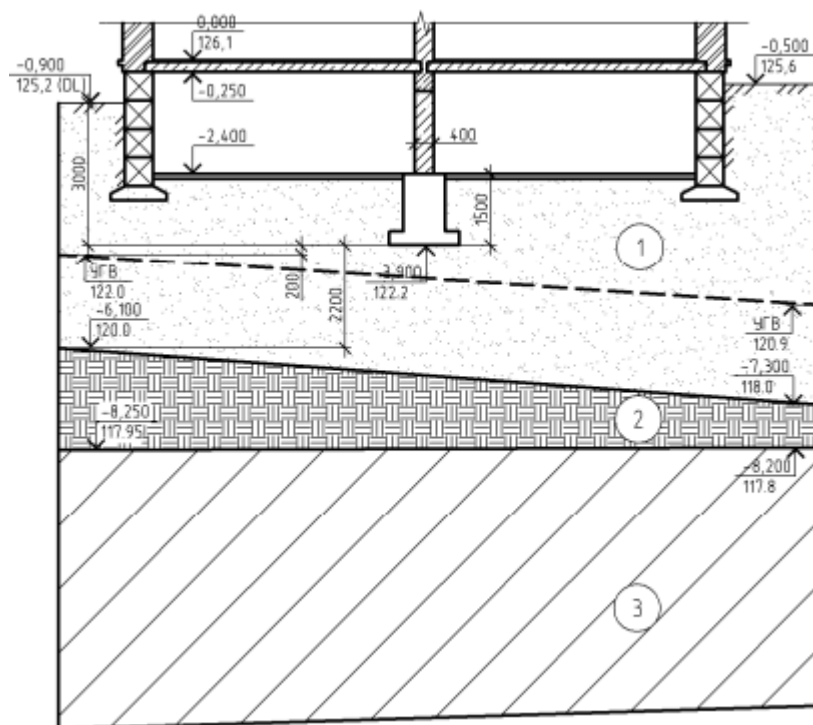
Схема к предварительному выбору фундамента мелкого заложения под колонну
